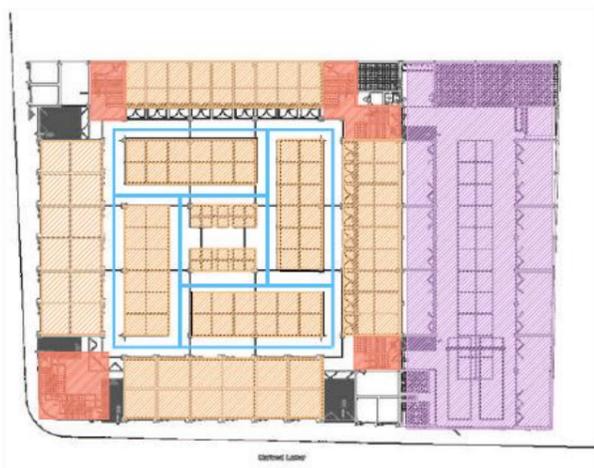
Distribución de puestos por tipo de productos en Mercado 3 de Noviembre en Planta Baja. Elaboración propia
